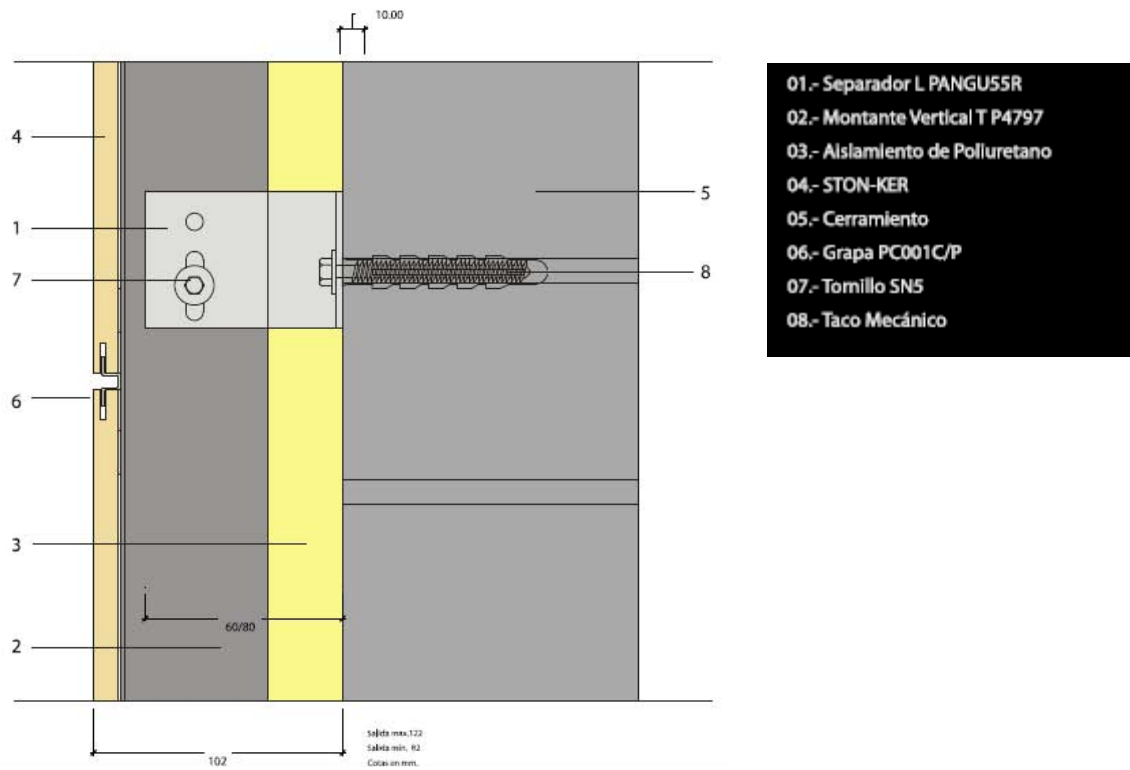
Detalle constructivo del catalogo STON-KER (Poreclanosa), sección horizontal
